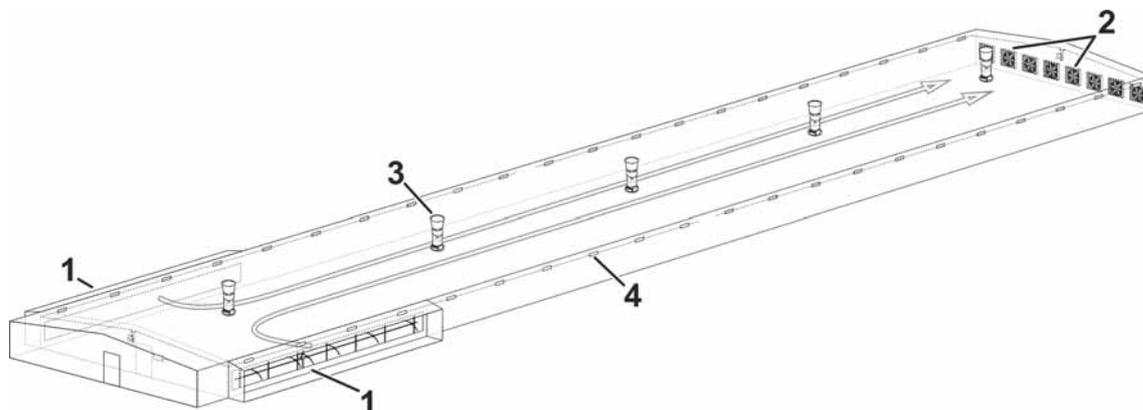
Пример вентиляционной системы (туннельная вентиляция)
